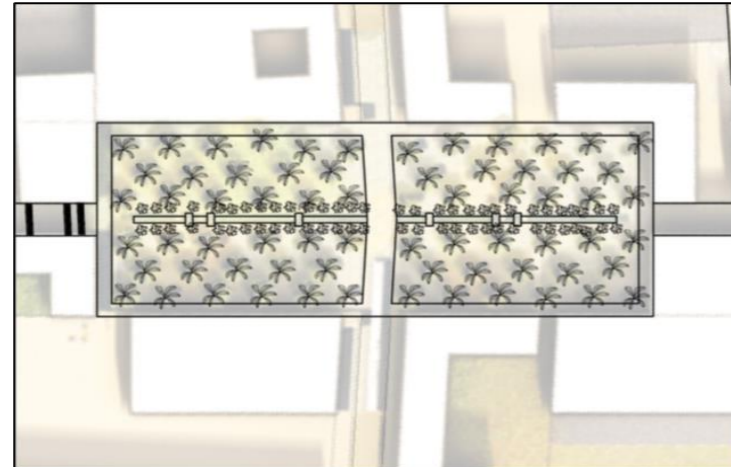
Vue en plan de la place central de la ville nouvelle de Ménée /
